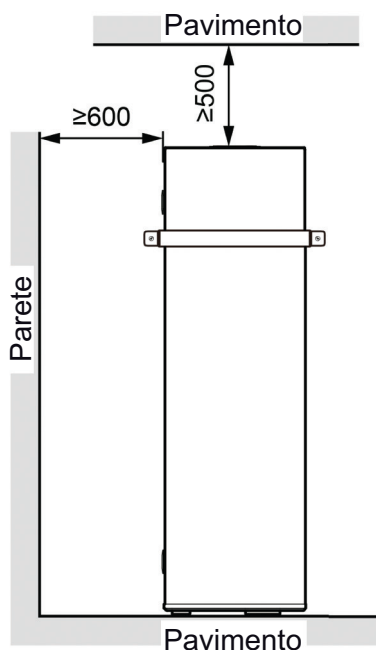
Schema di installazione del Water Tank (Unità: mm)
